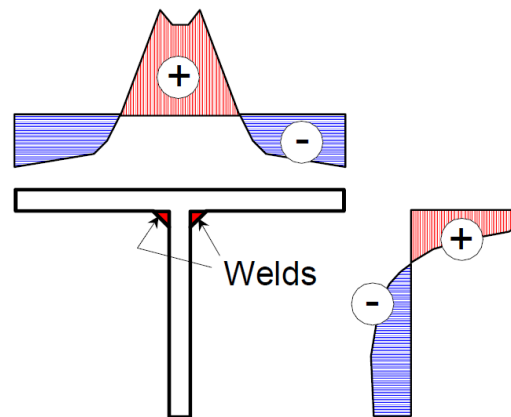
Tensões residuais num perfil em T soldado [20]
